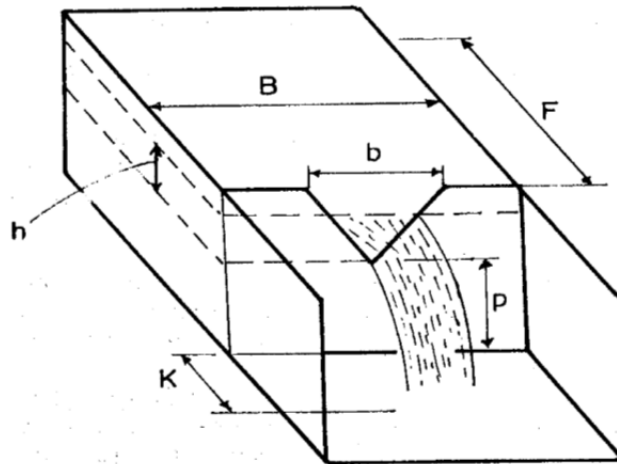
Dimensiones de Vertedero V-notch 45°
